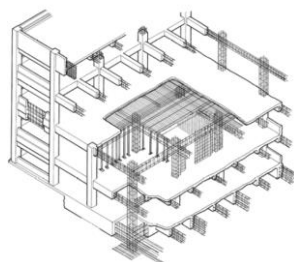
Exemplo de estrutura de quadro rígido de concreto armado
